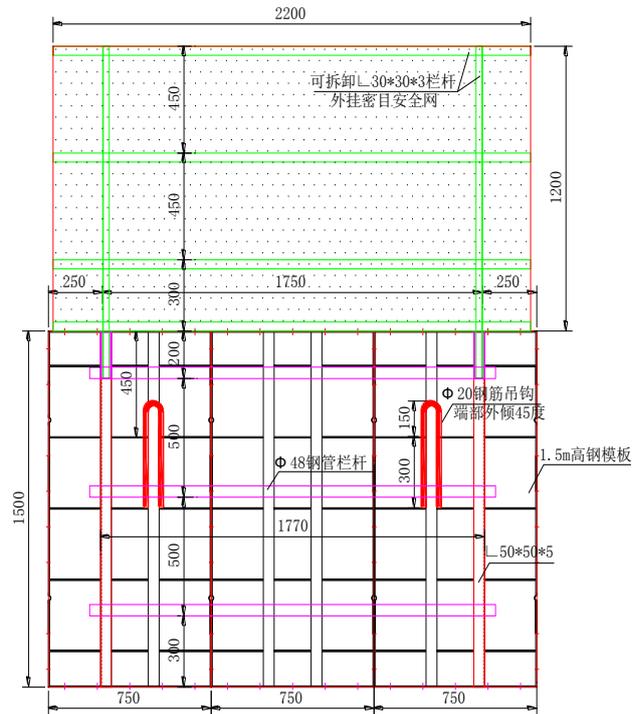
模板钢架施工平台布置正立面图 (单位: mm)
